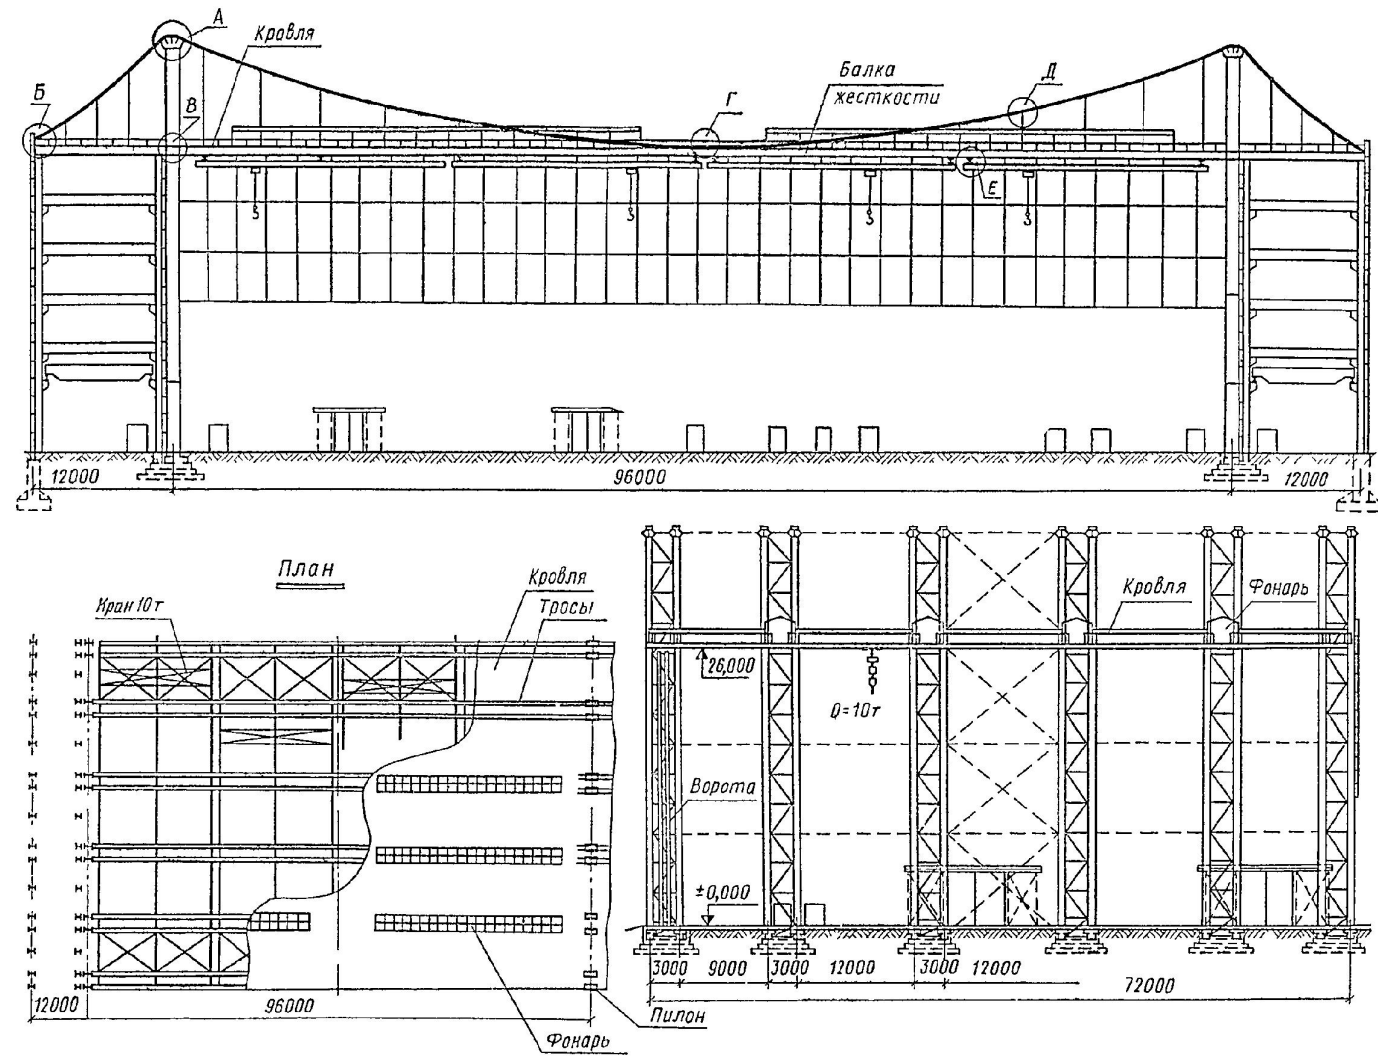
а. Промышленное здание с висячим покрытием. План, разрез
